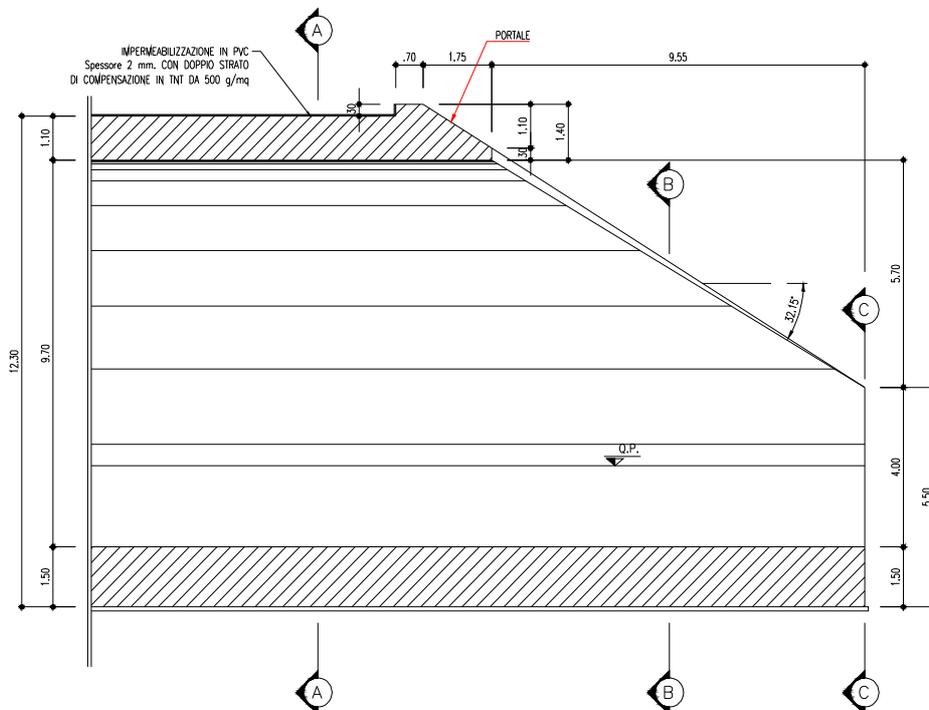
sezione tipo di imbocco PE lato caltanissetta
